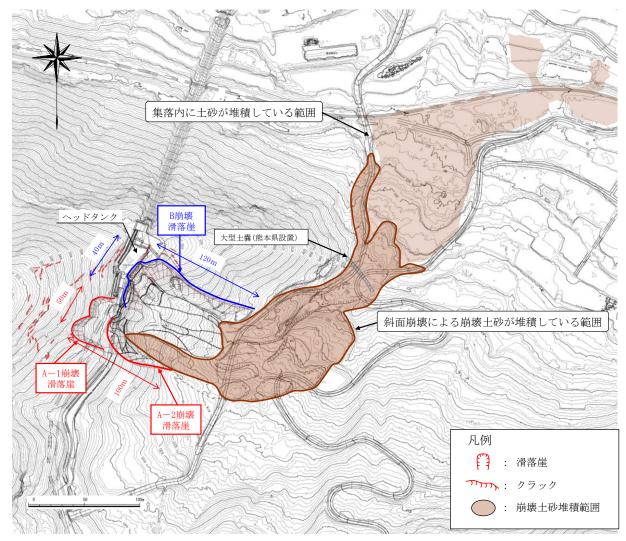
黒川第一発電所ヘッドタンク付近で発生した斜面崩壊の平面図
